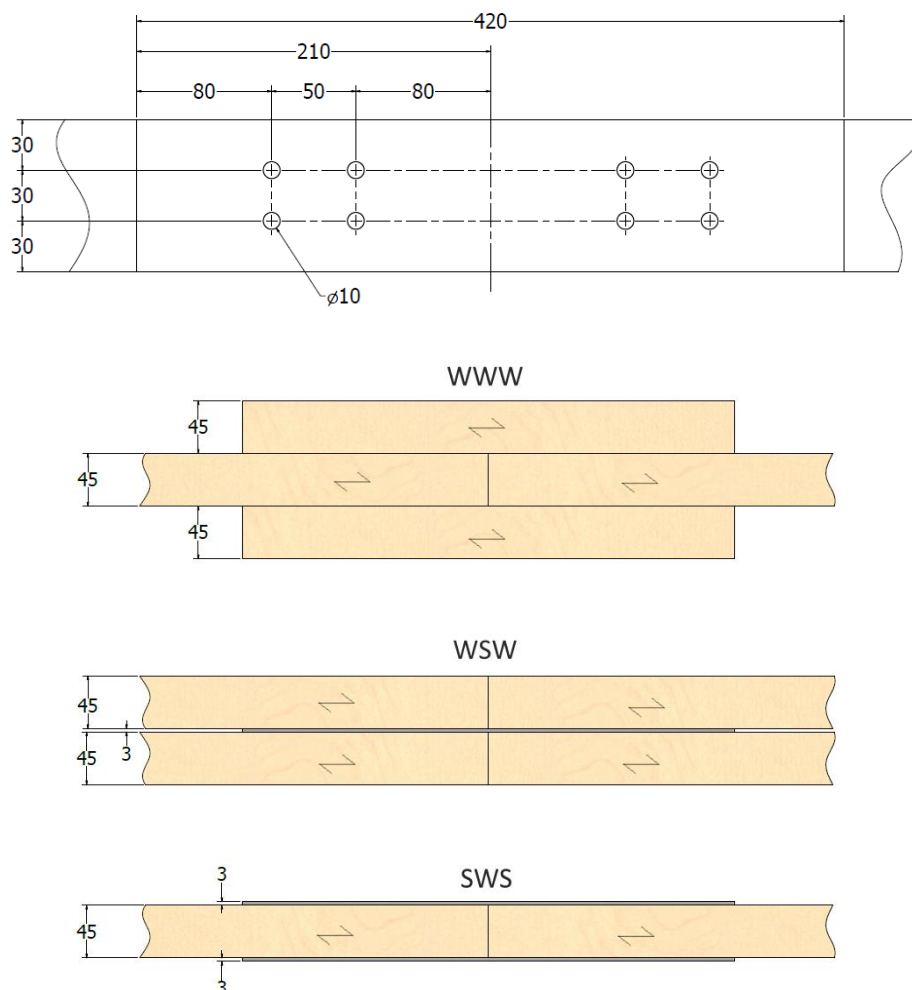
Dimensões das ligações em estudo e posicionamento das cavilhas
